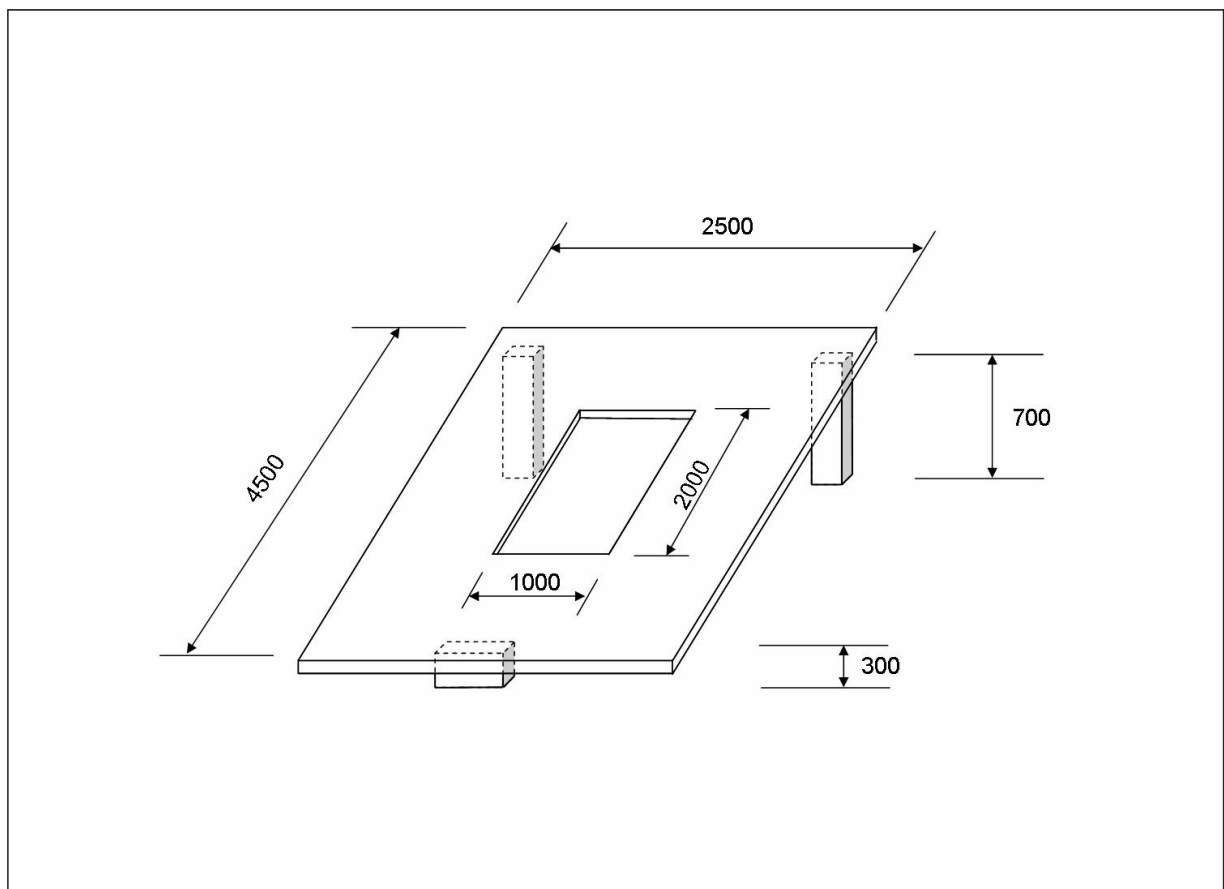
Betonspezialelement „Algentisch mit Öffnung“
